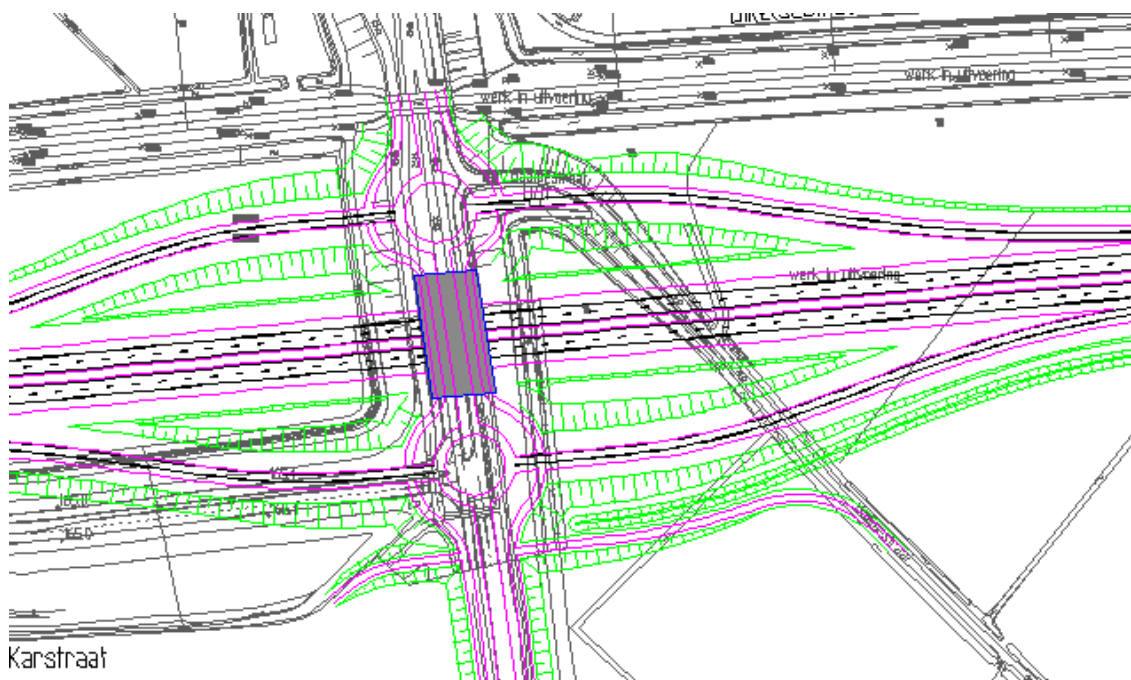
Aansluiting Bommel en plan Houtakker
